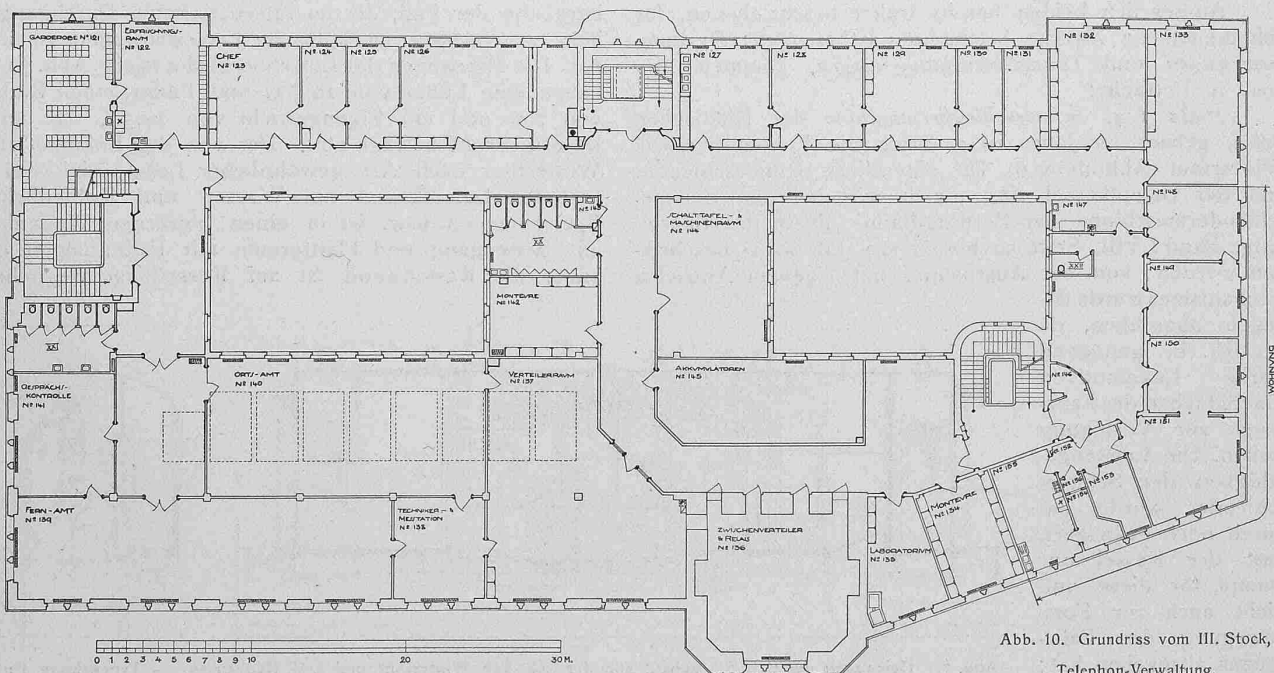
Grundriss vom III. Stock, Telephon-Verwaltung.
